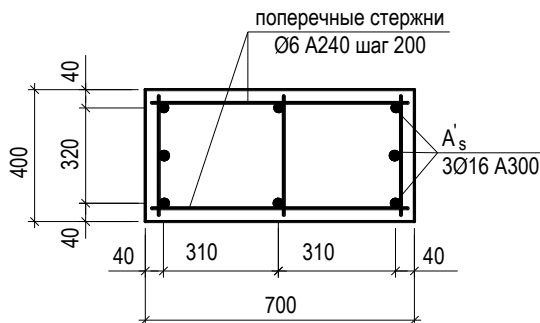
Армирование подкрановой части колонны (сечения 4-4)
